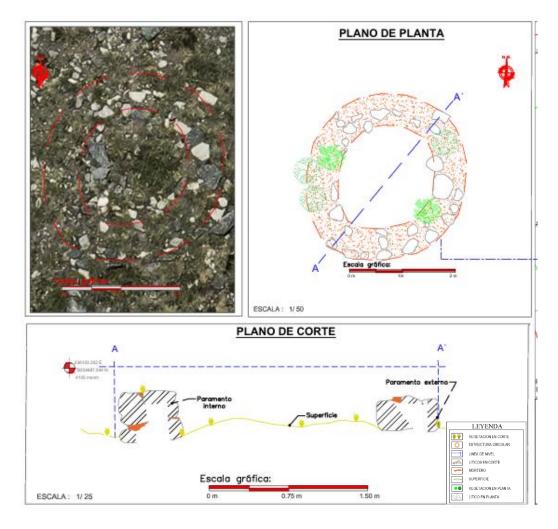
Dibujo de planta y corte de la Estructura domestica (Ed-01)
